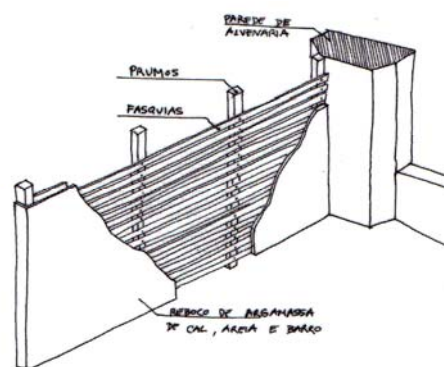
Elementos construtivos do tabique, retirado de [Lamas, 2003]
